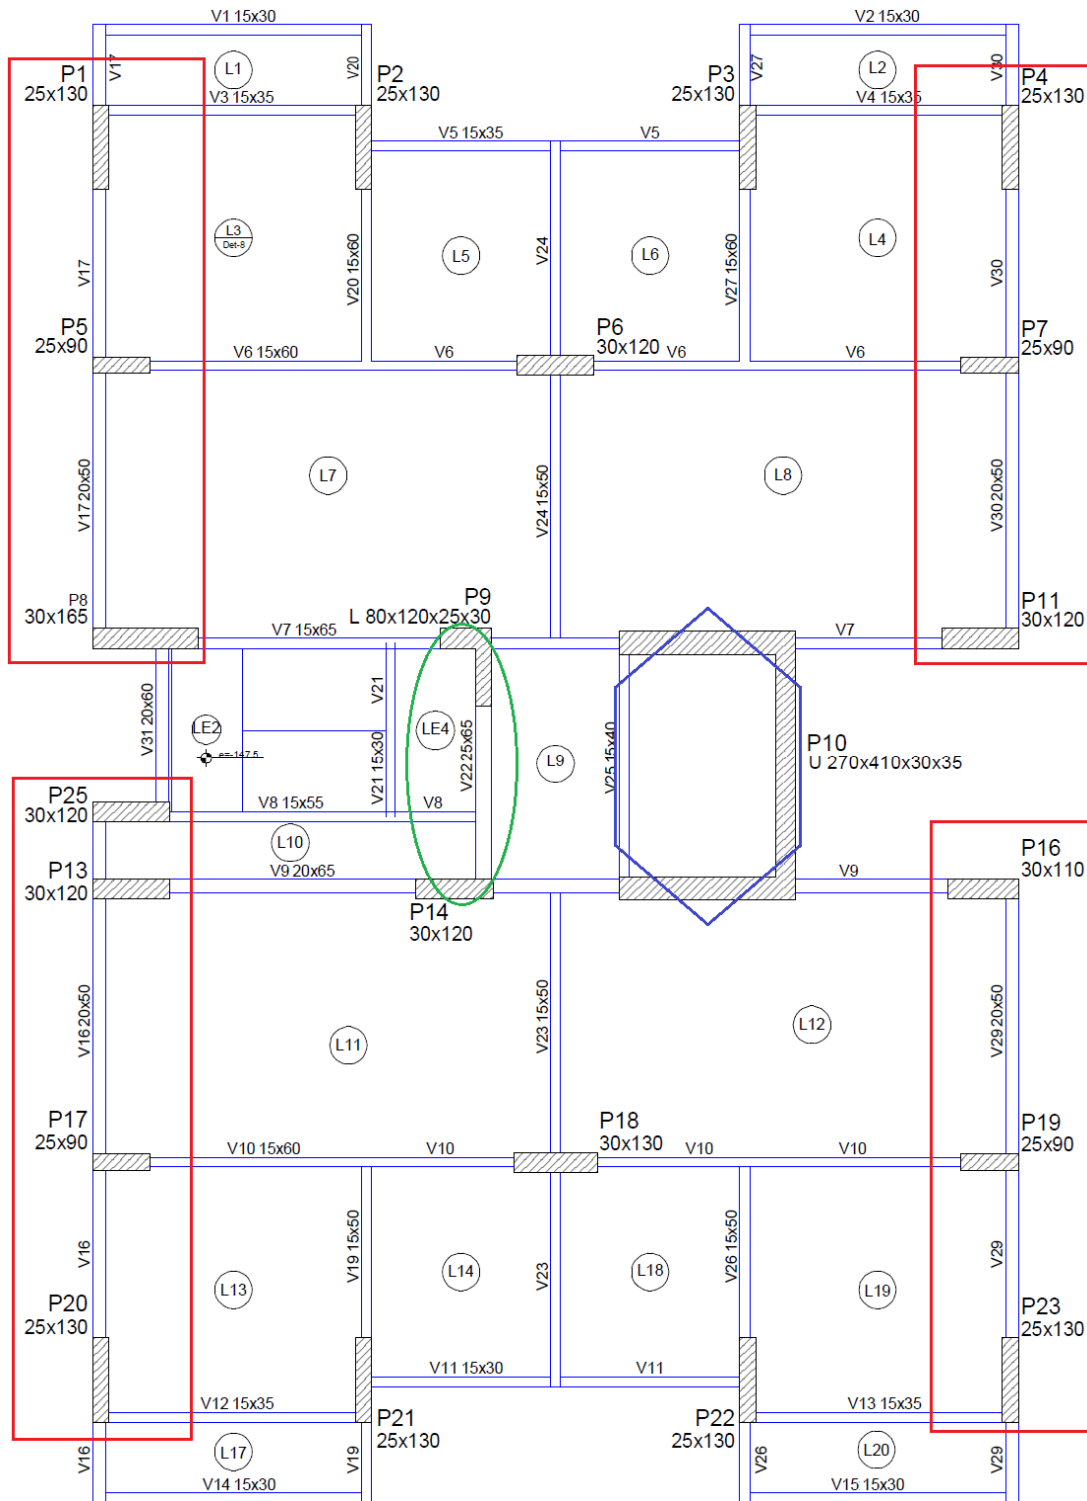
Planta de forma do pavimento tipo - Modelo Estrutural com Pórtico de contraventamento, Pilares-parede e Núcleo rígido – direção “x”.
